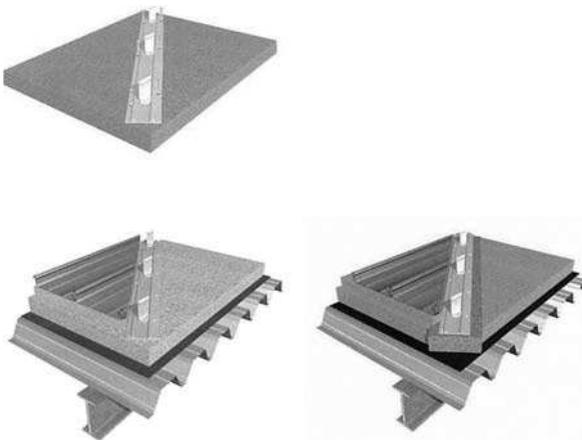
Dachaufbau System „Pro-Dach“ mit Drehklipp-Schiene und Drehklipps – unten links: flächendeckende trittfeste Dämmung, unten rechts: Streifen aus trittfester Dämmung in Verbindung mit Dämmmatten
